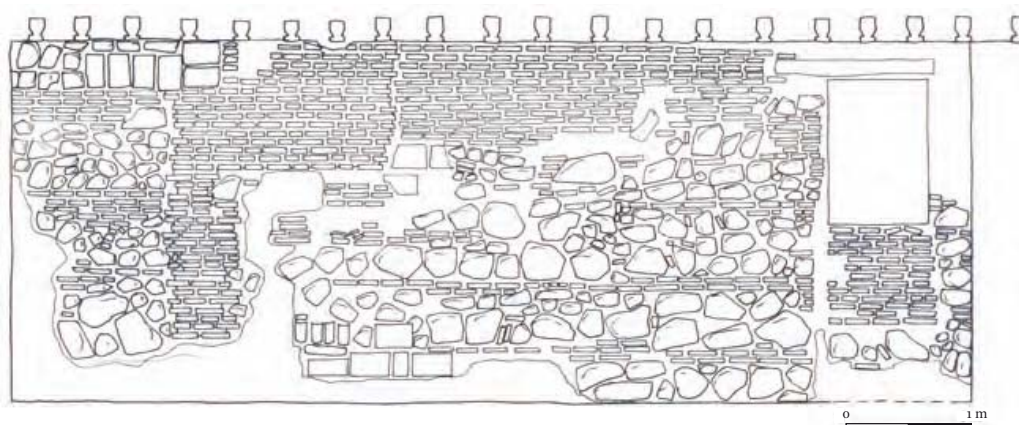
Calle de Santa Úrsula 11. Primer muro (fachada exterior norte).
